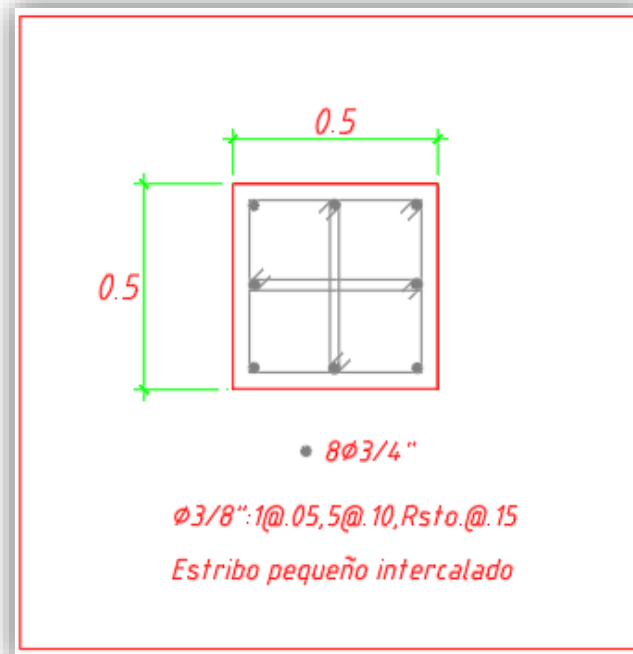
Detalle de refuerzo en columna C1 y C2 piso 1 al 3
